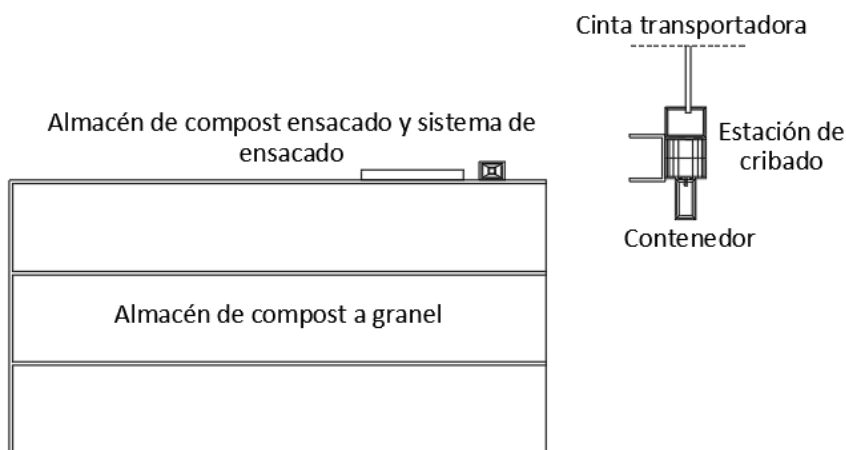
Vista en planta del área de almacenamiento. Fuente: Elaboración propia
